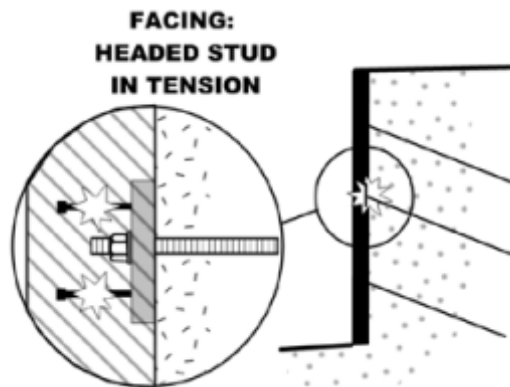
Esquema de rotura de los elementos de conexión (Fuente: Soil Nail Walls – Reference Manual (FHWA, 2015))
